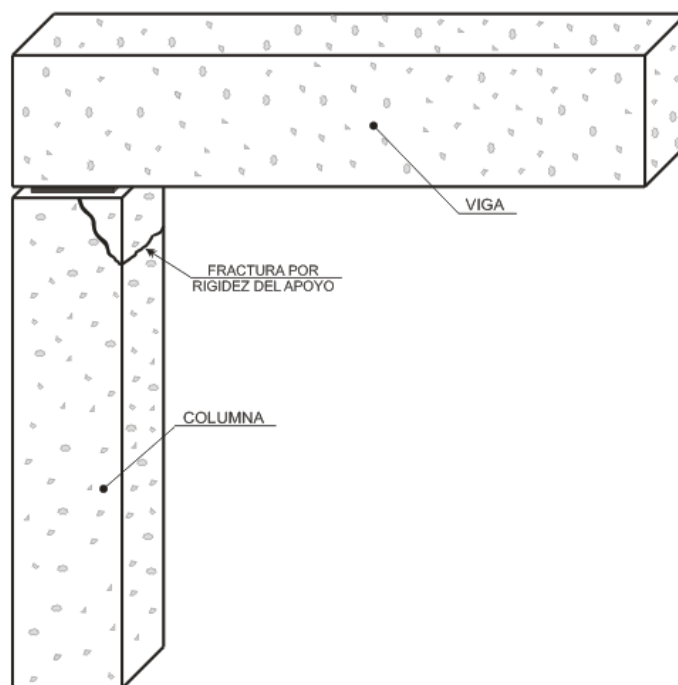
Patrón de fractura de borde, por rigidez del apoyo.
